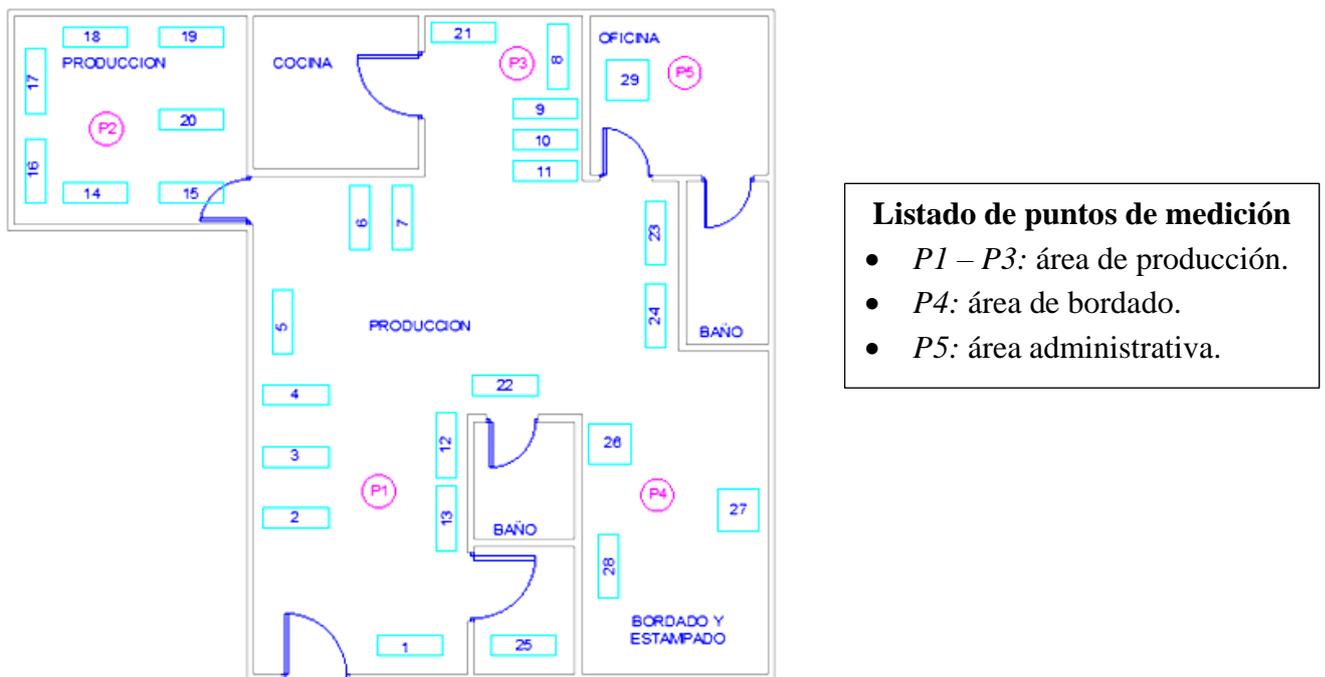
Layout de la distribución de los puntos de medición en la planta baja
